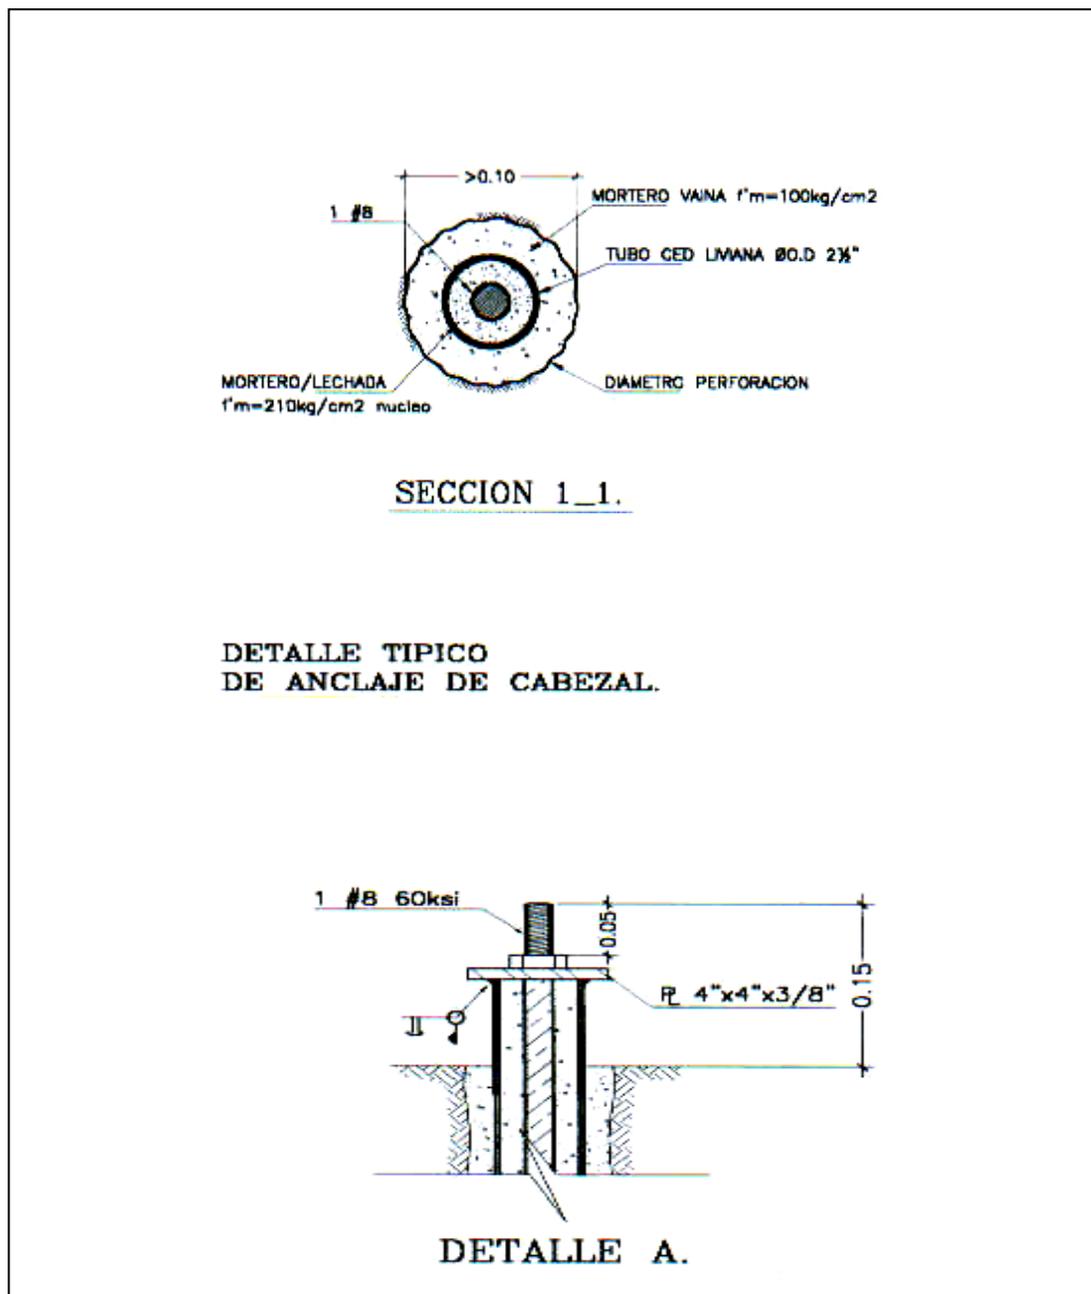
Detalle de la sección del micropilote y detalle típico de anclaje de cabezal
